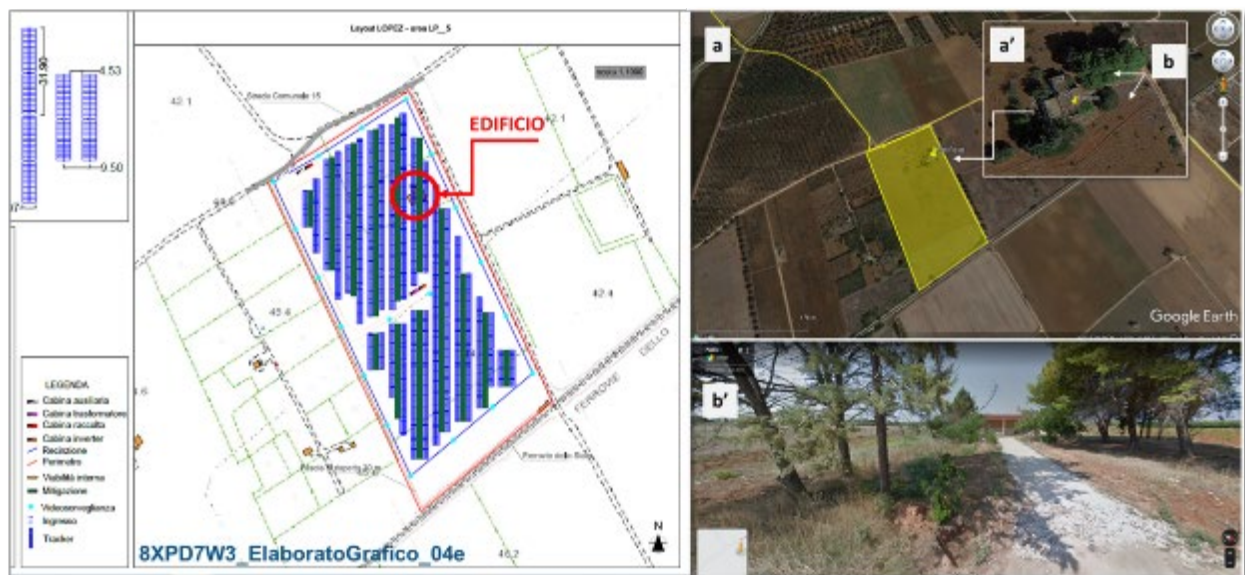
Lotto LP_5: rappresentazione planimetrica di progetto e Localizzazione dell'edificio attualmente presente in LP_5: localizzazione (a), vista di dettaglio (a') punto di ripresa Panoramio (b) e ripresa da Panoramio (b') - Elaborazione della Commissione
